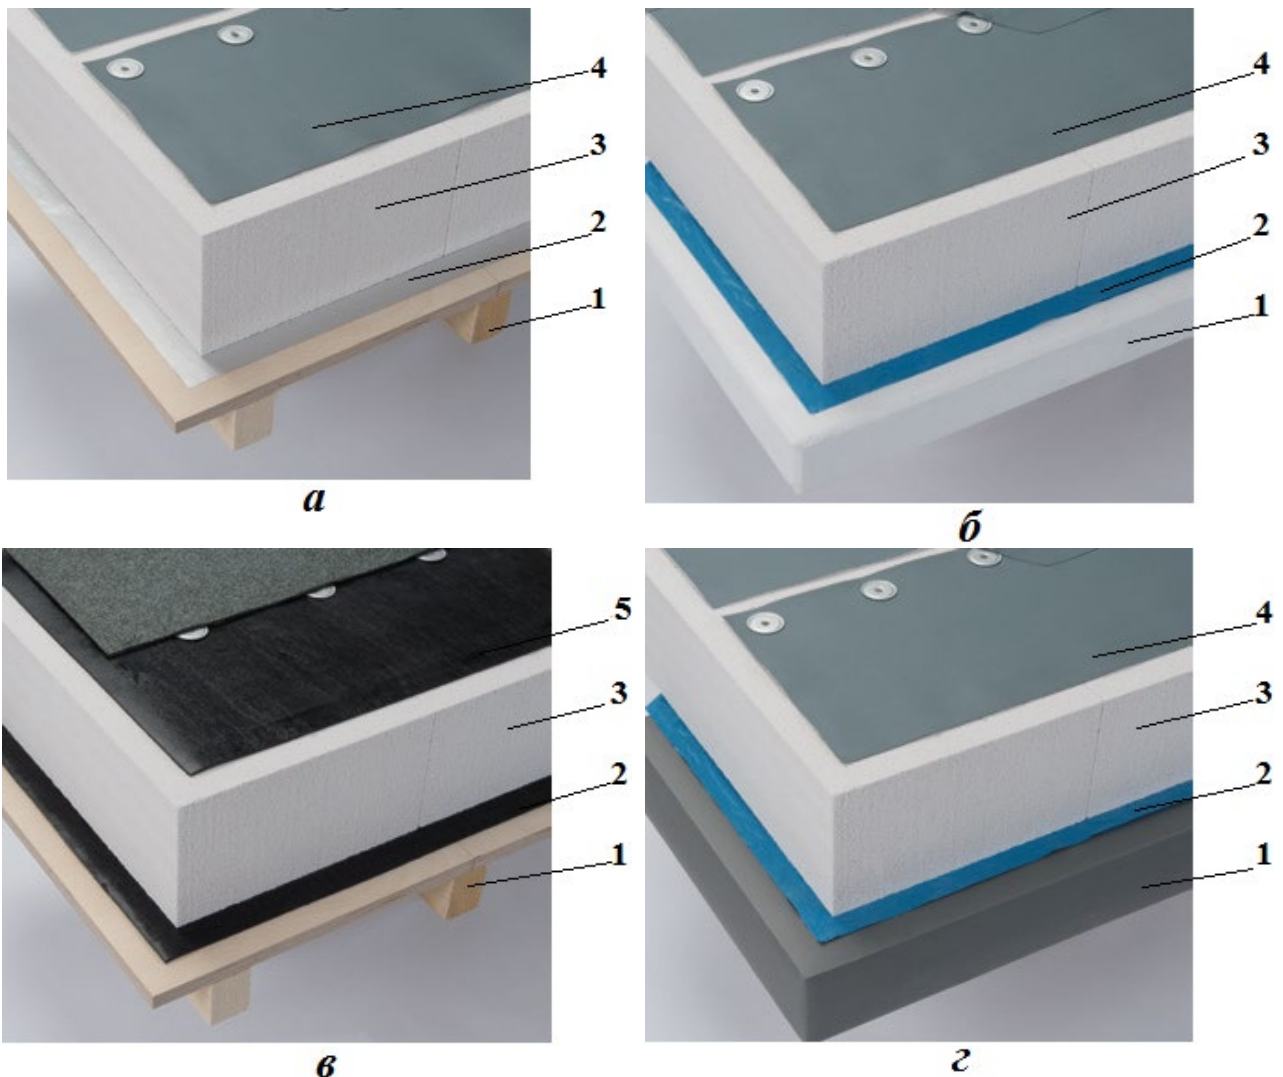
Кровельная система с механическим закреплением: а, в — по деревянному основанию; б — по газобетонной плите; г — по железобетонному перекрытию; 1 — основание; 2 — пароизоляция (а — многослойная алюминиевая фольга; б, г — полиэтиленовая пленка; в — битумная с грунтовкой); 3 — минеральная изоляционная плита; 4 — полимерная кровельная мембрана; 5 — многослойный полимербитумный рулонный материал приваренный
